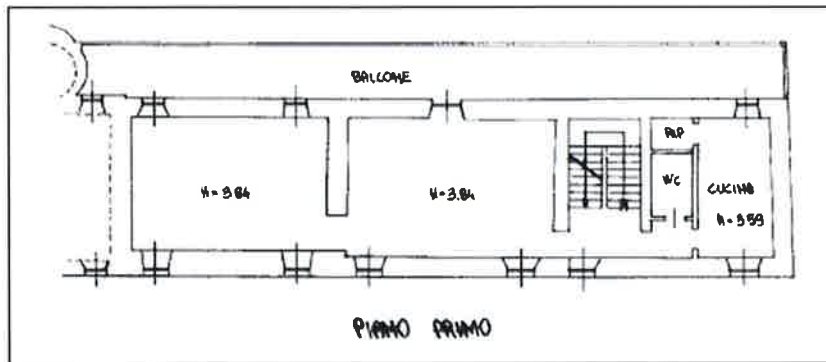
planimetria catastale del piano primo dell'abitazione identificata con la particella 1184 sub 5
